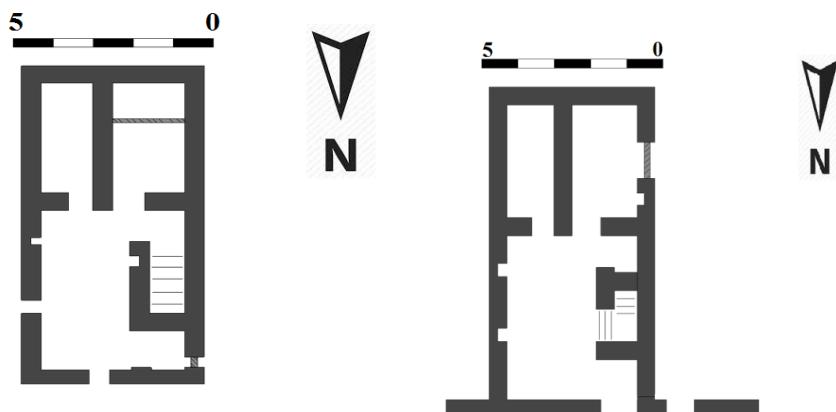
المسقط الافقى للطابق العلوي لمنزل
